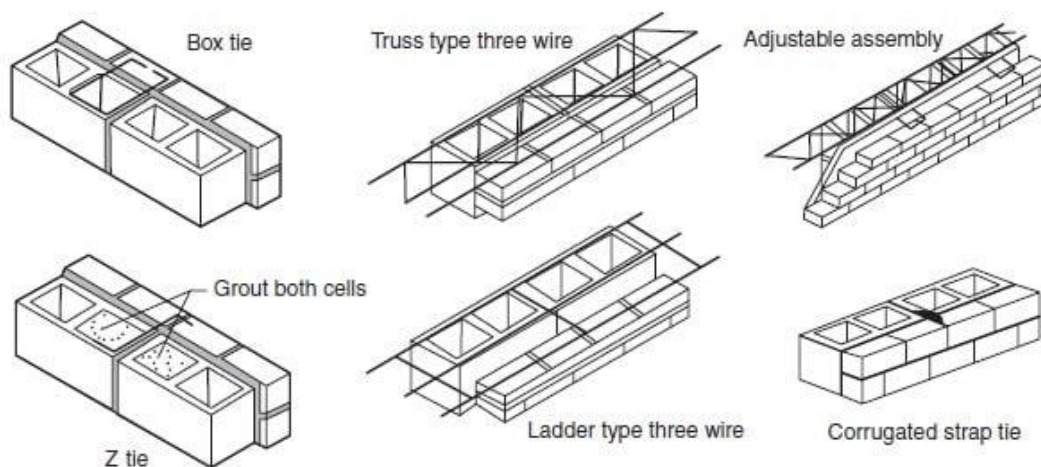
Aplicaciones de refuerzo de juntas en la construcción de estructuras de mampostería. Fuente: ("Types of Masonry Walls in Building Construction," n.d.)
